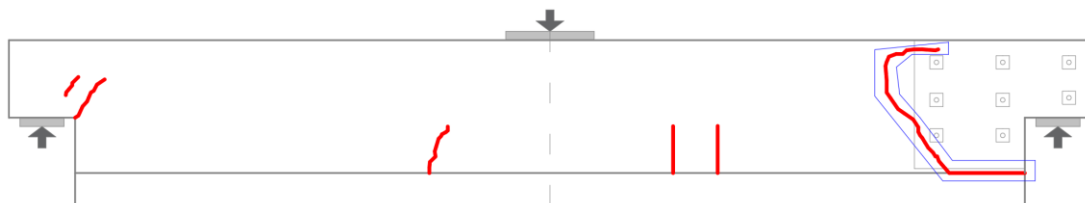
Quadro fessurativo sperimentale, trave A, schema statico 1, termine prova [2]
